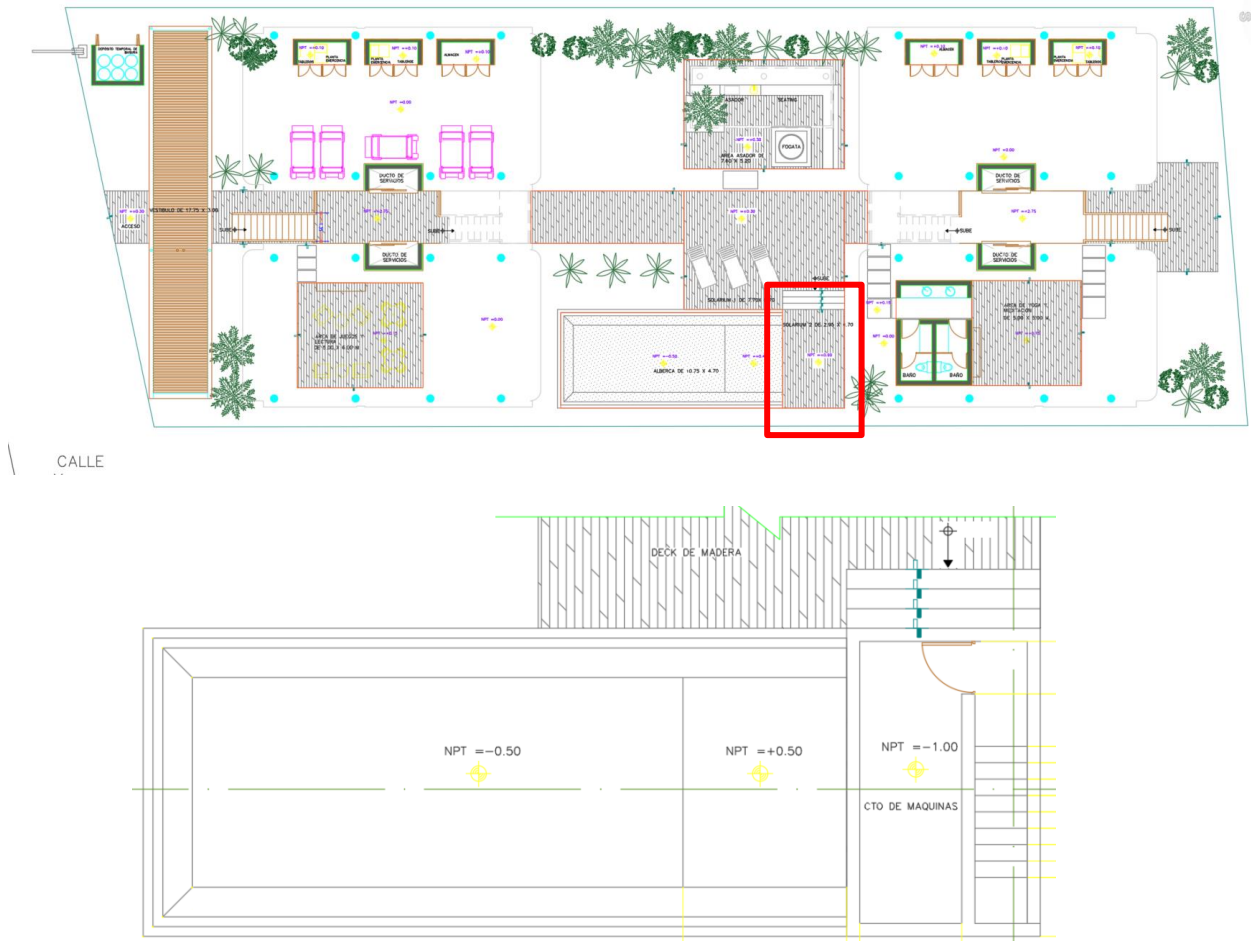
Plano con la ubicación del cuarto de maquinas
